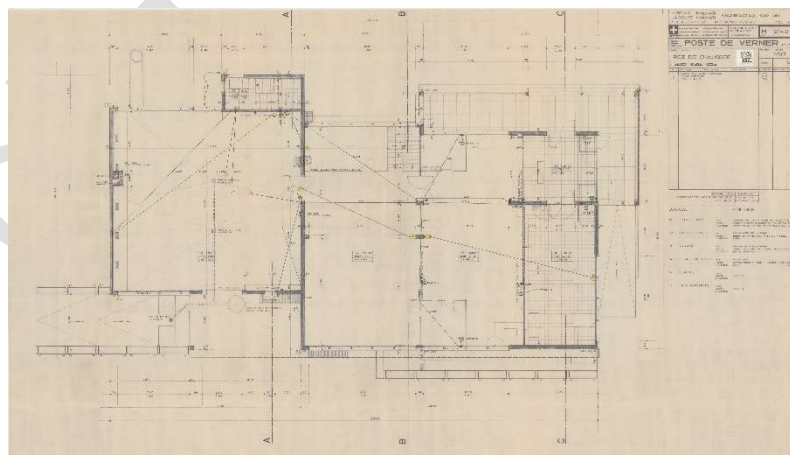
Ancien bureau de poste : Plan du rez-de-chaussée
